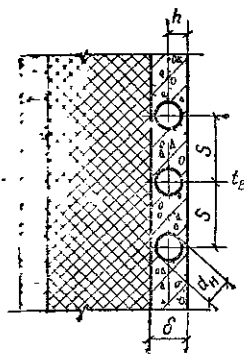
Эскиз размещения нагревательного элемента в наружной стеновой панели
